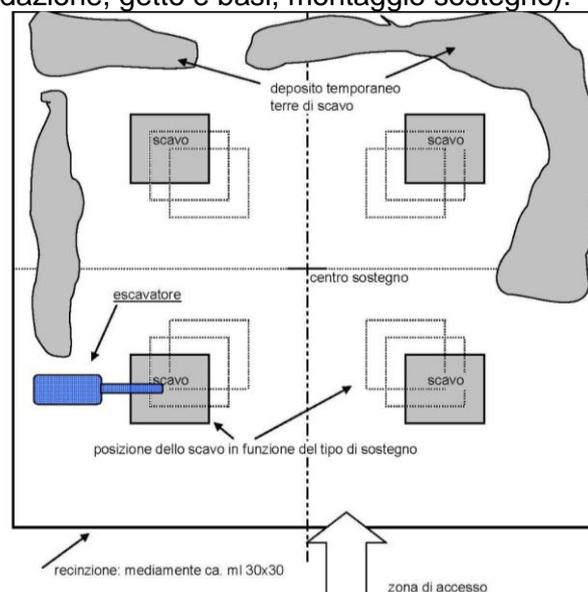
Planimetria dell'area di microcantiere (linea 380 kV) - fase di lavoro: scavo di fondazione
